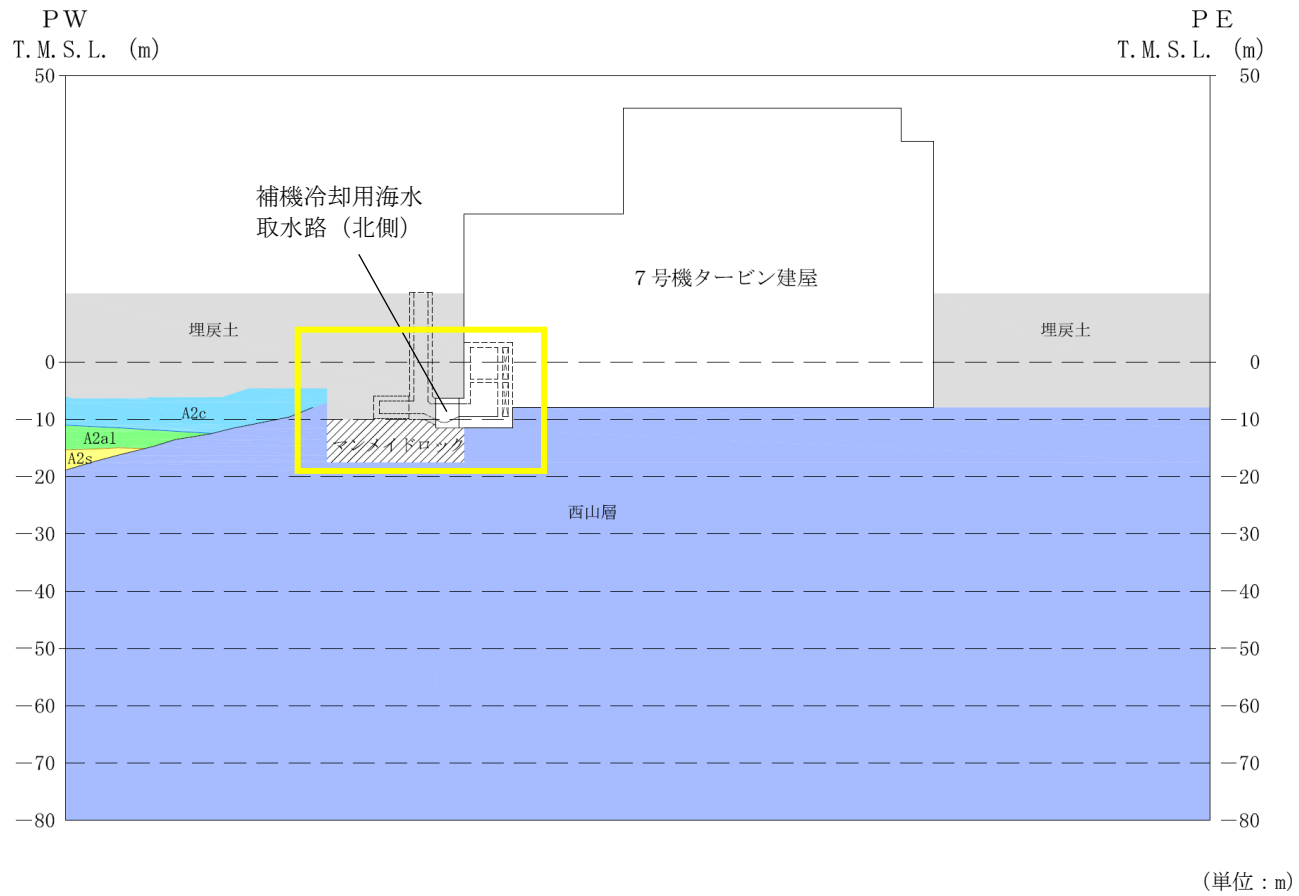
補機冷却用海水取水路 (北側) の縦断方向周辺地質断面図 (C-C断面)
